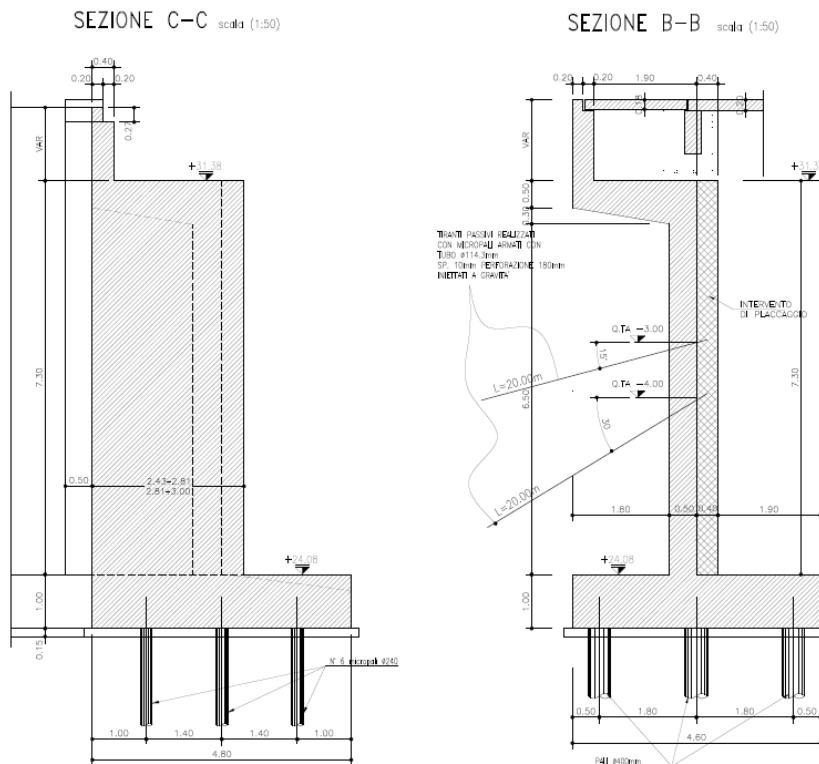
Sezione trasversale spalla lato Milano: B-B spalla originaria con placcaggio e tiranti; C-C spalla ampliamento 2004
